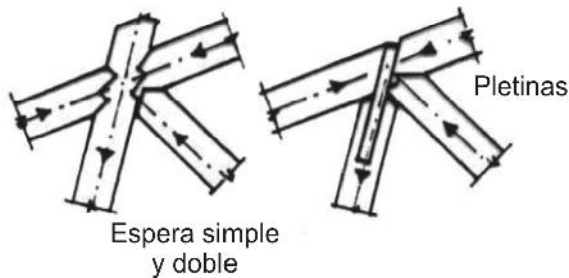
Unión de Par-Tirantilla-Tornapunta.
